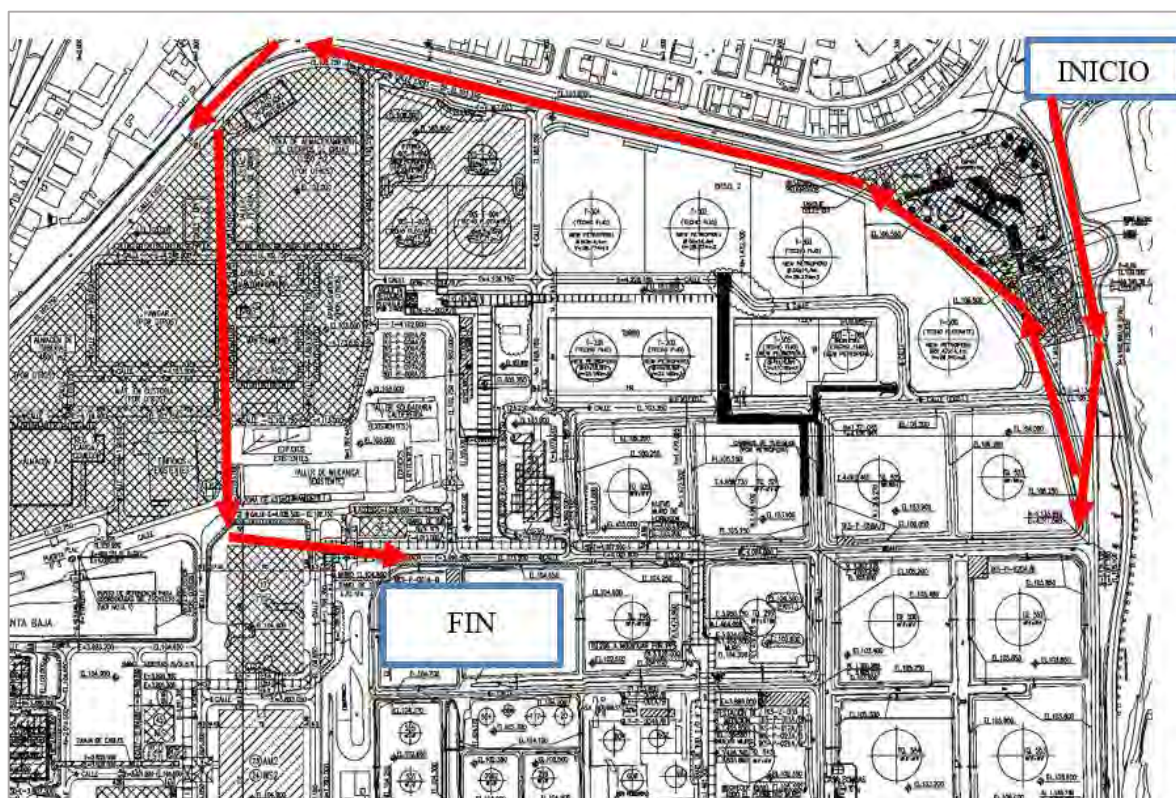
Ruta de recorrido en refinería de pórticos (carga ancha)
